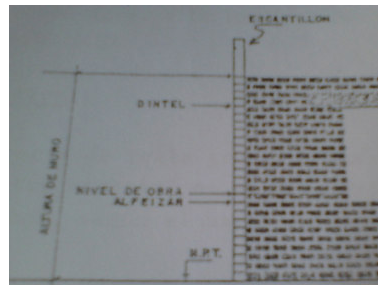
Uso de escantillón en levantamiento de muros (SENCICO 1991)
